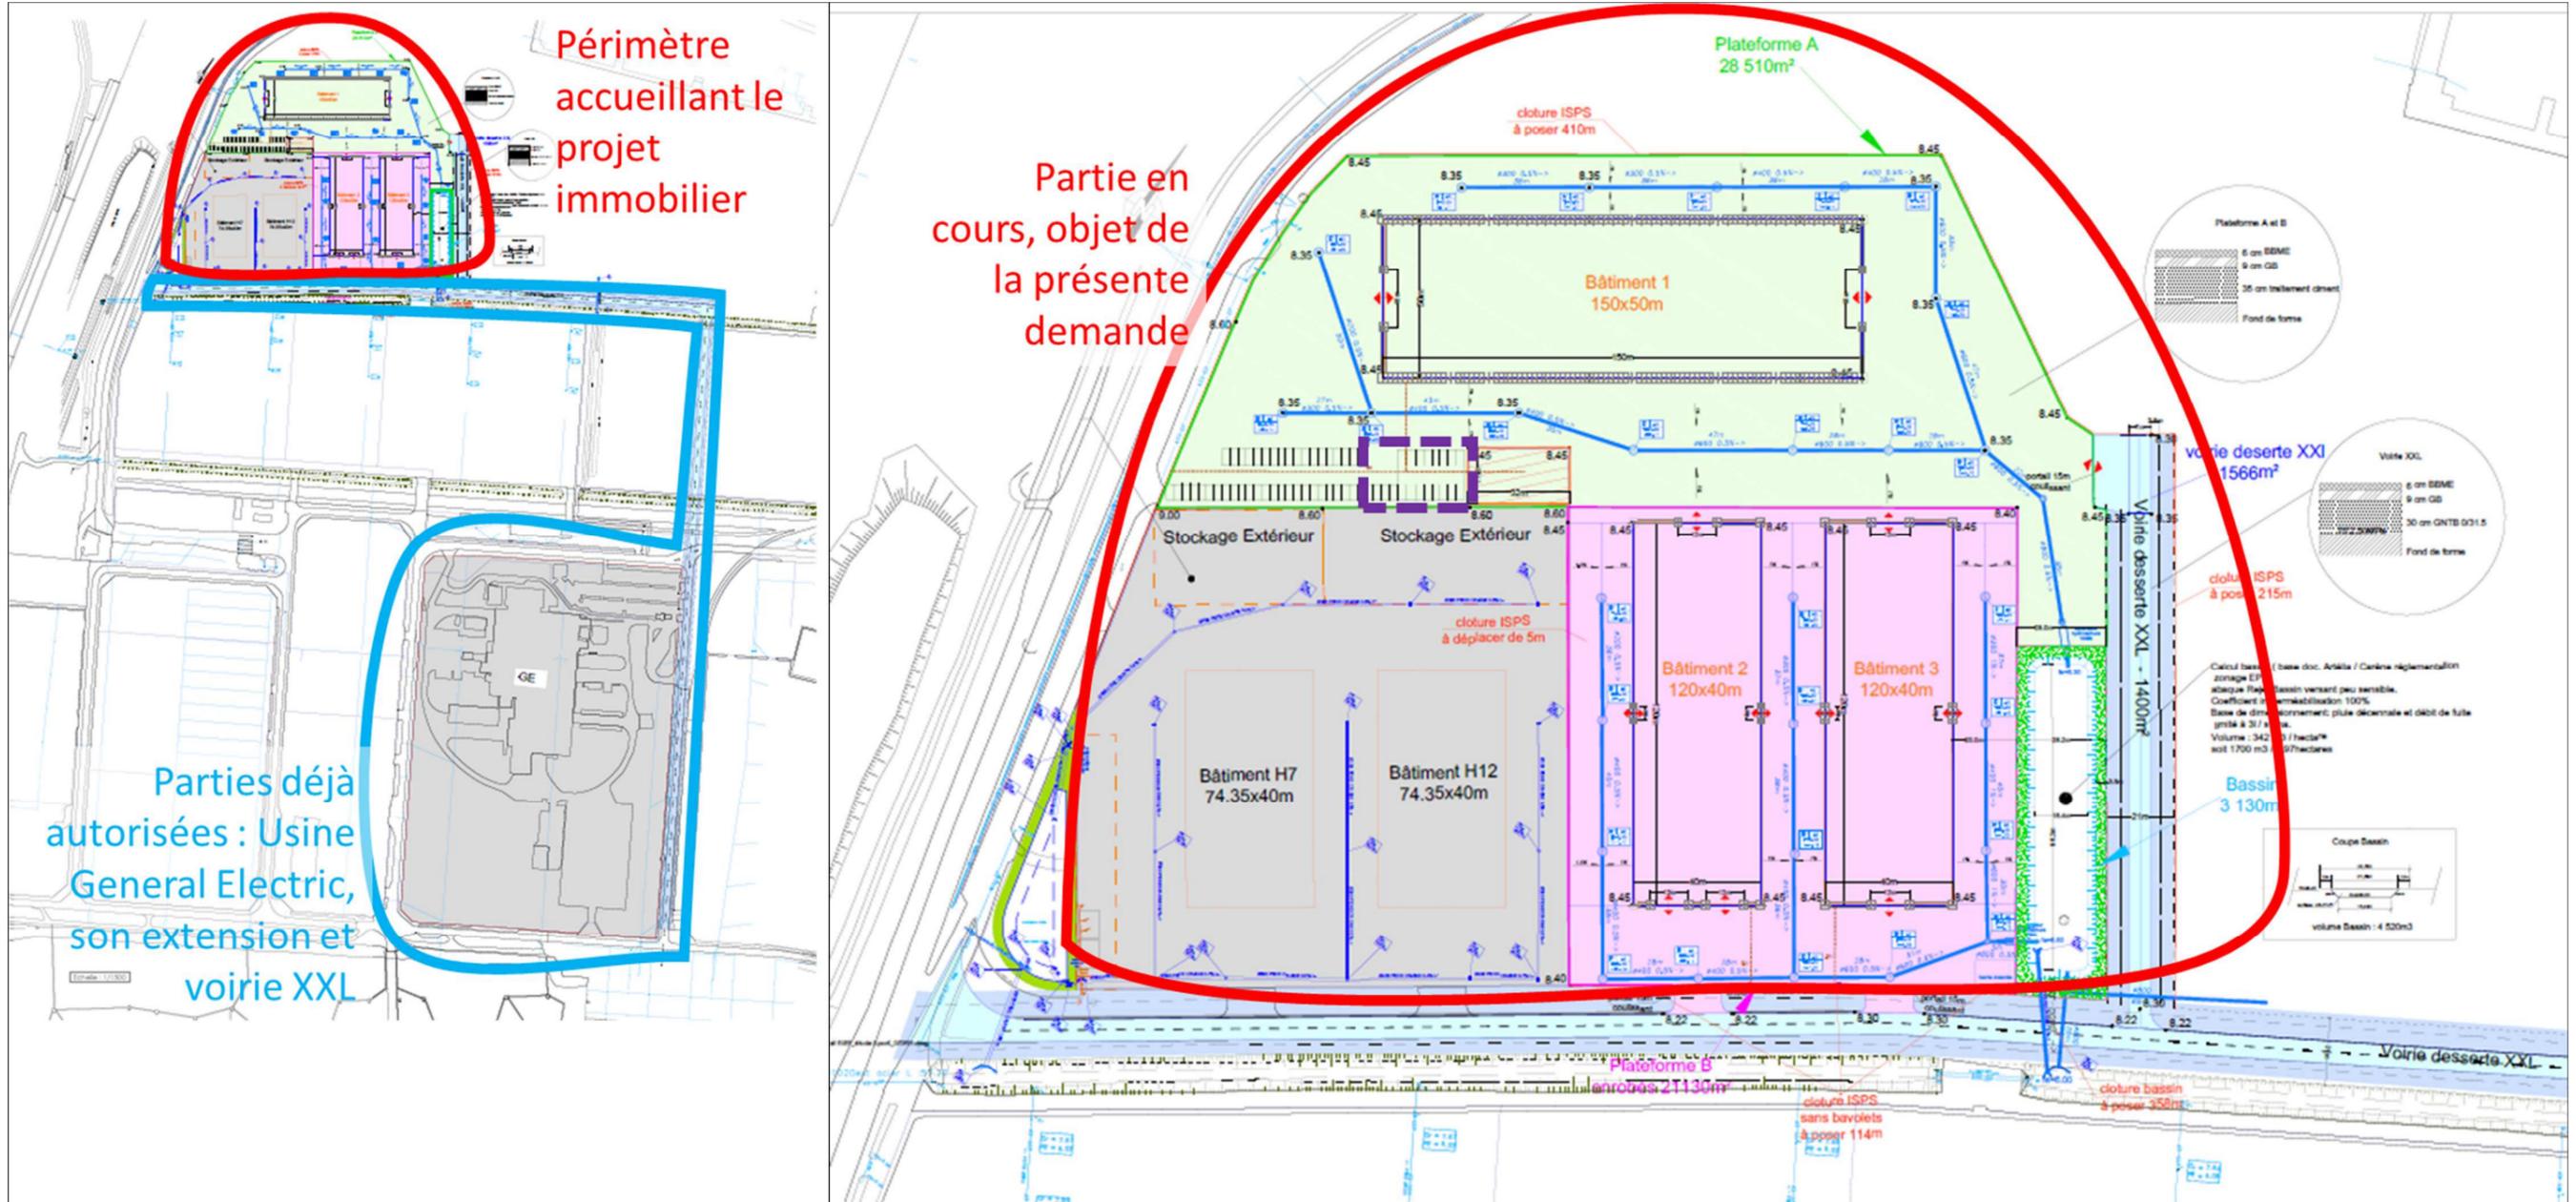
Emplacement du projet immobilier par rapport à l'usine GE (à gauche) et plan des constructions (à droite)
